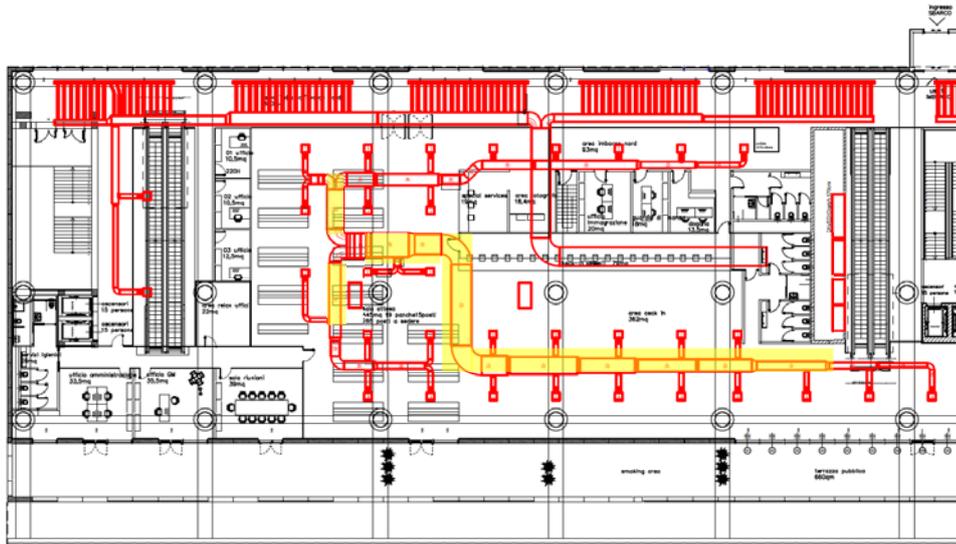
Edificio terminal; pianta piano primo (lato nord), breakout dorsali (raffigurate in giallo) che attraversano gli ambienti
